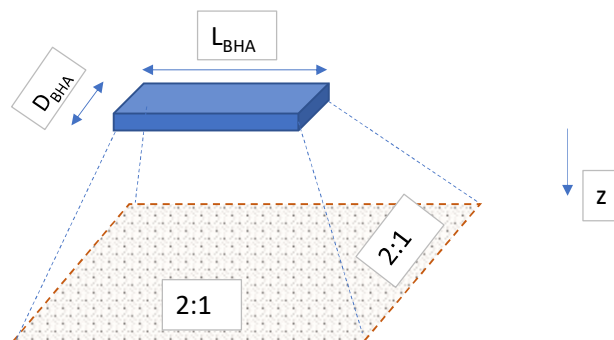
Zakking Bottom Hole Assembly door OverCut (OC).
